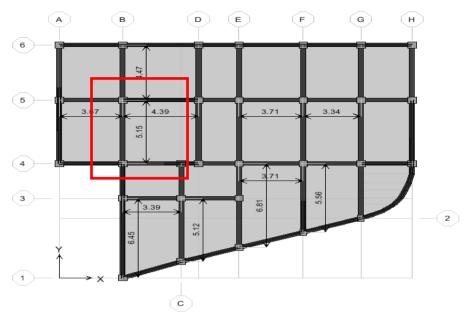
Panneaux de dalle du radier (e = 40cm)
